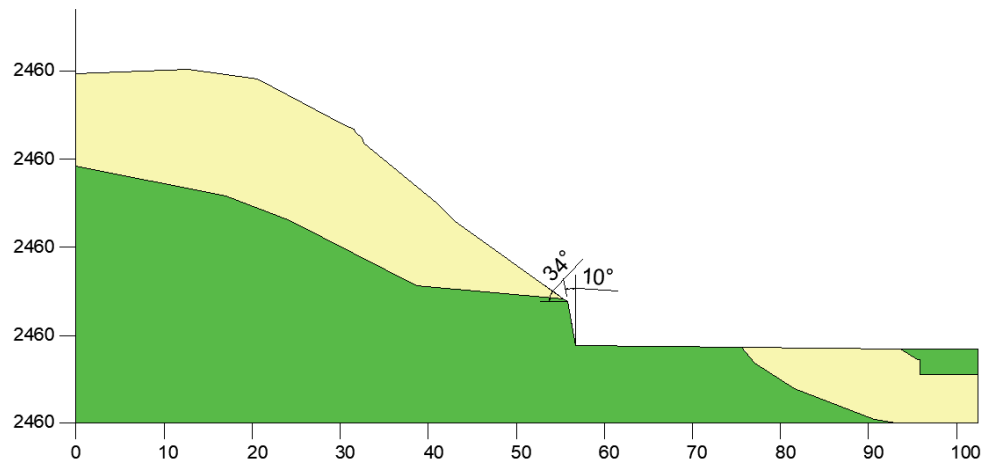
Geometría del talud propuesto – Soil nail, talud IESS.
